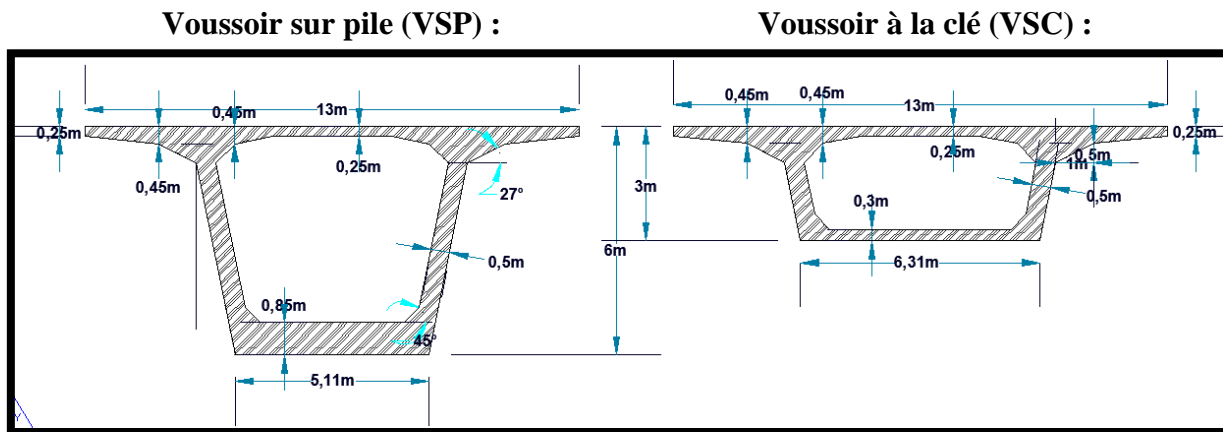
Section transversale du voussoir sur pile et du voussoir à la clé
